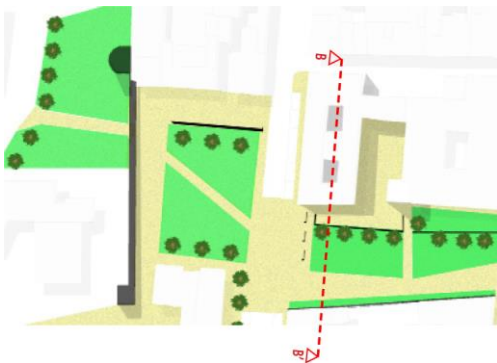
SEZIONE B-B' / STATO DI PROGETTO
